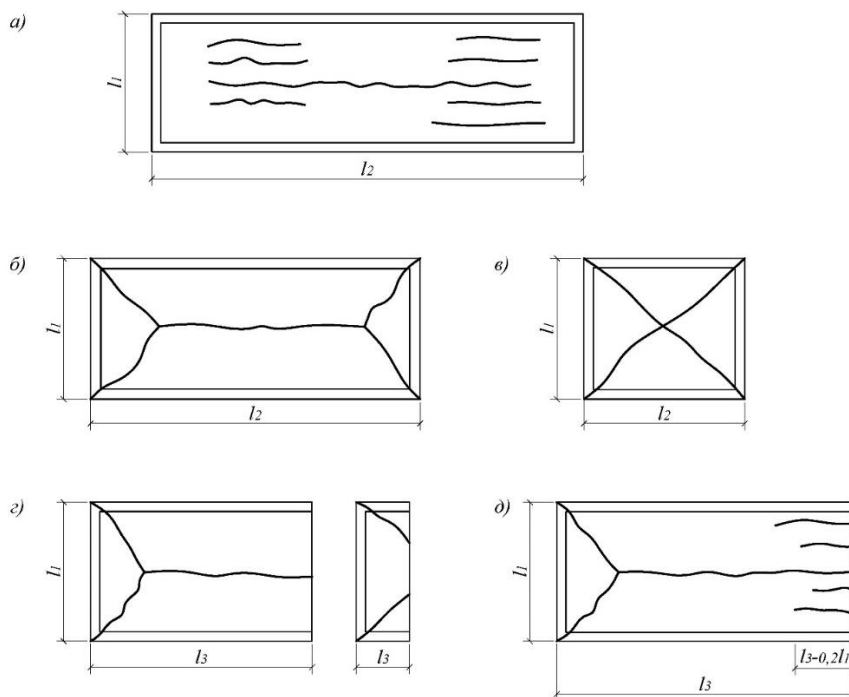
Трещины по нижней поверхности плит перекрытия и покрытия (в растянутой зоне): а – работающих по балочной схеме; б, в – опертых по контуру; г – опертых по трем сторонам, при $l_3/l_1 \leq 1,5$; д – опертых по трем сторонам, при $l_3/l_1 > 1,5$.
